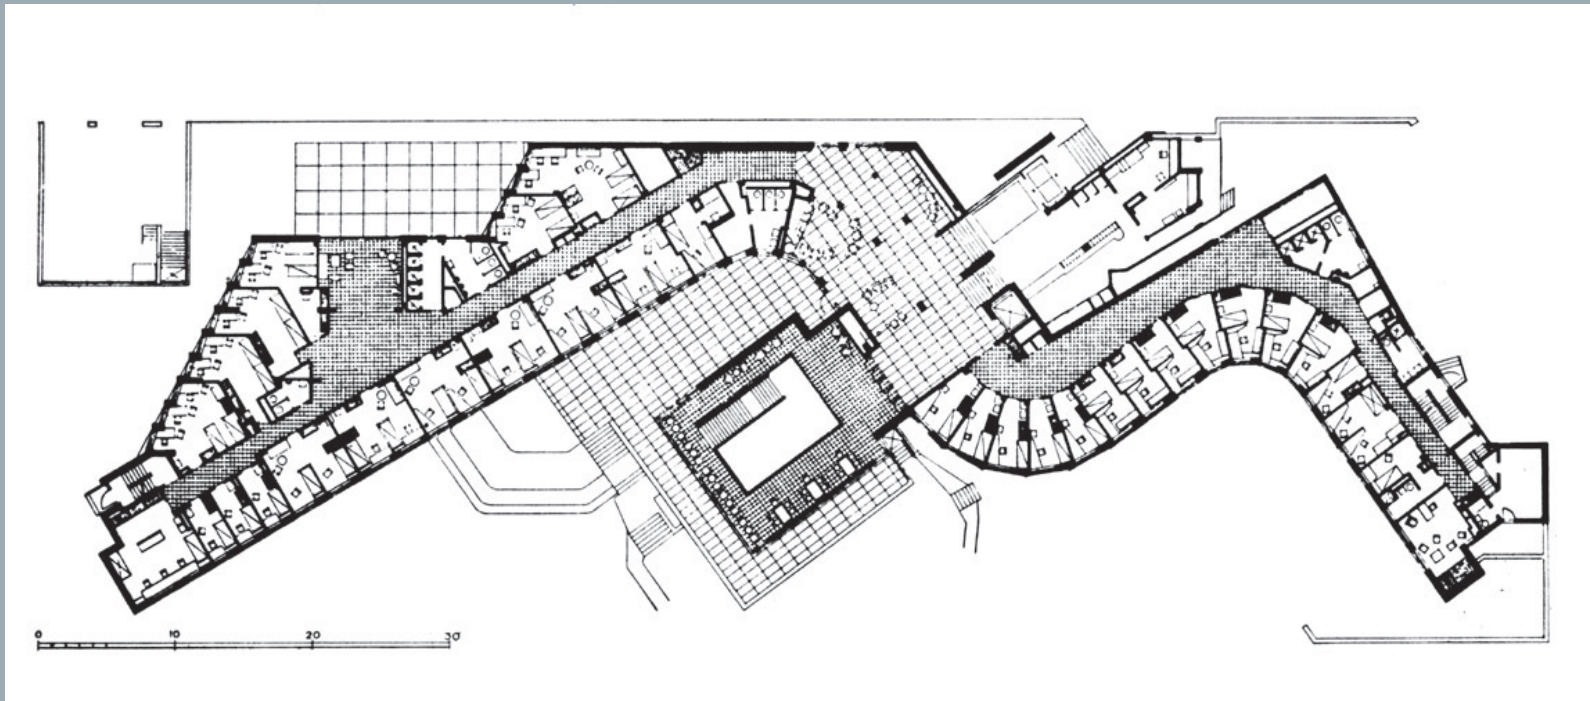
Planimetría primera planta (Architeam, 2015)
